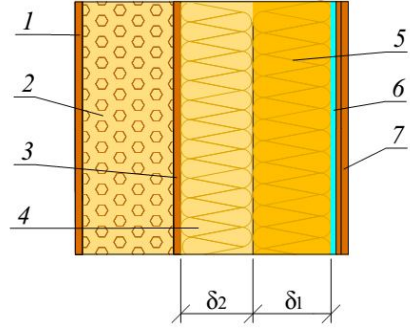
Стена из газобетонных блоков с внутренним утеплением: 1 – штукатурка; 2 – газобетонный блок (кладка); 3 – стяжка; 4, 5 – теплоизоляция; 6 – гидроизоляция; 7 – внутренняя обшивка
